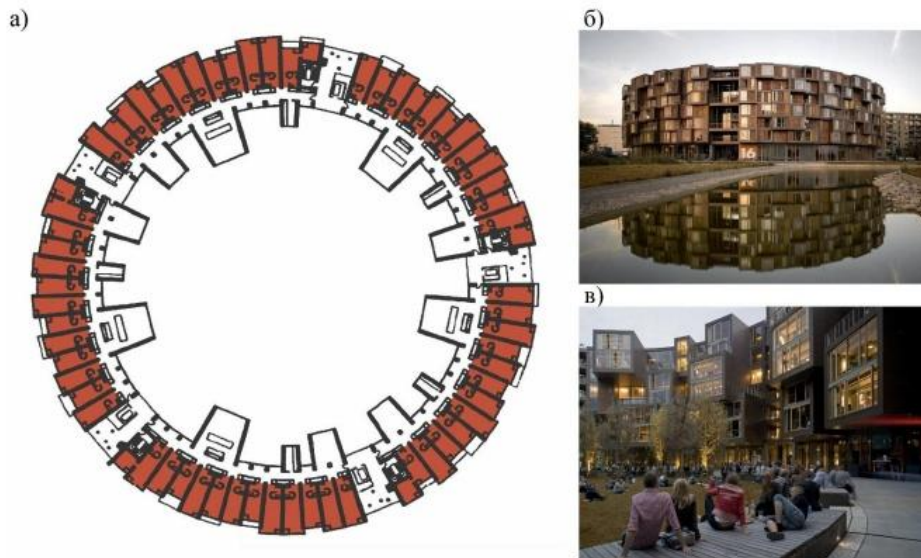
Tietgen Dormitory у м. Копенгаген, Данія архітектурне бюро Lundgaard & Tranberg Architects (а – план типового житлового поверху, б – фасад, у – внутрішній двір).
